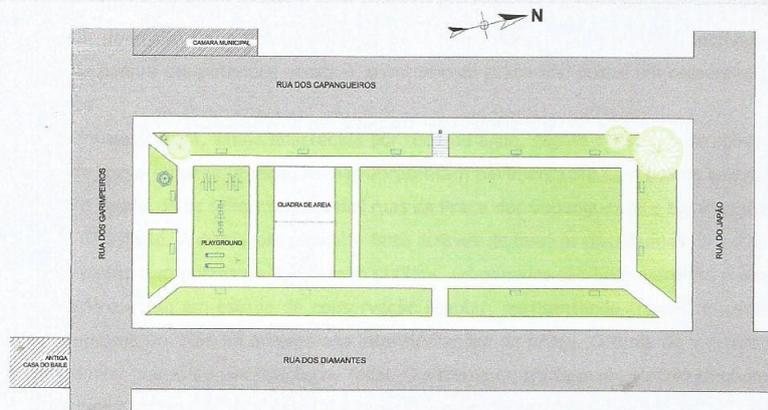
Planta Esquemática - Praça dos Capangueiros - s/escala. Novembro/2010 Autor: Adriana Ferreira
